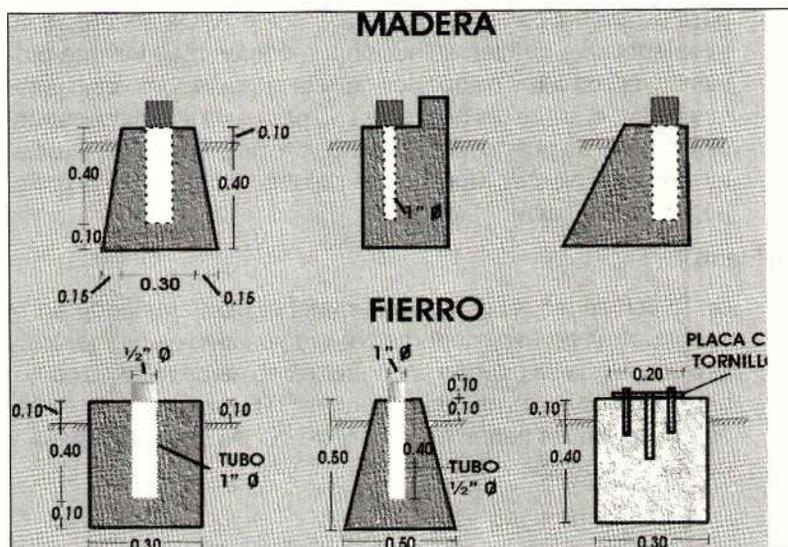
Tipo de zapatas para cimentación en invernaderos.
